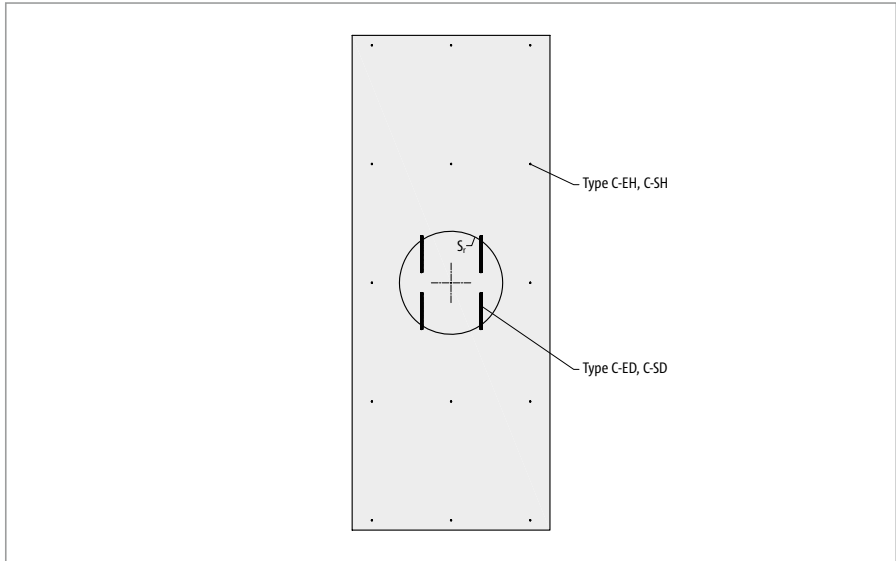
Schöck Isolink® : panneau extérieur suspendu ; le type C-ED, C-SD est disposé à l'intérieur d'un cercle autour du point de repos à la déformation du panneau extérieur
